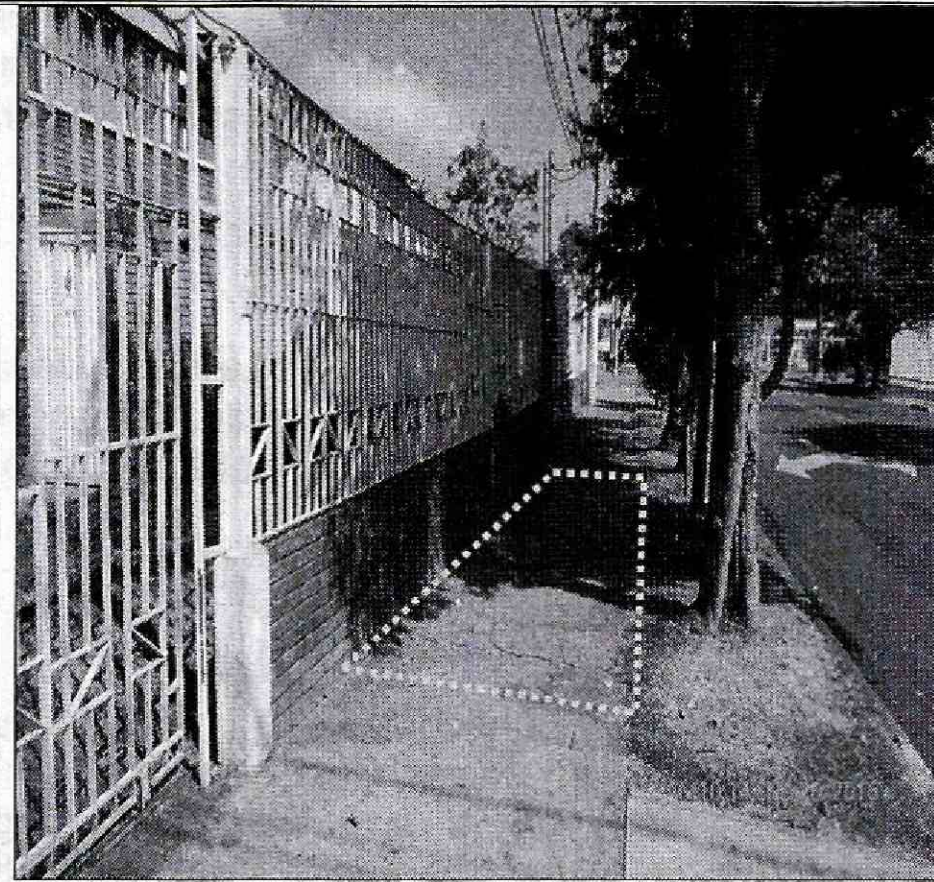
Separación entre mampuestos en el cerramiento del costado oriental de la vivienda ubicada en el predio de la Carrera 70 A No. 123 - 03 en el Sector Catastral Niza Sur de la Localidad Suba.
